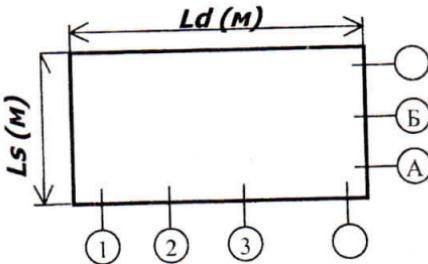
Схема этажа здания по наружному обмеру с осевой разбивкой
